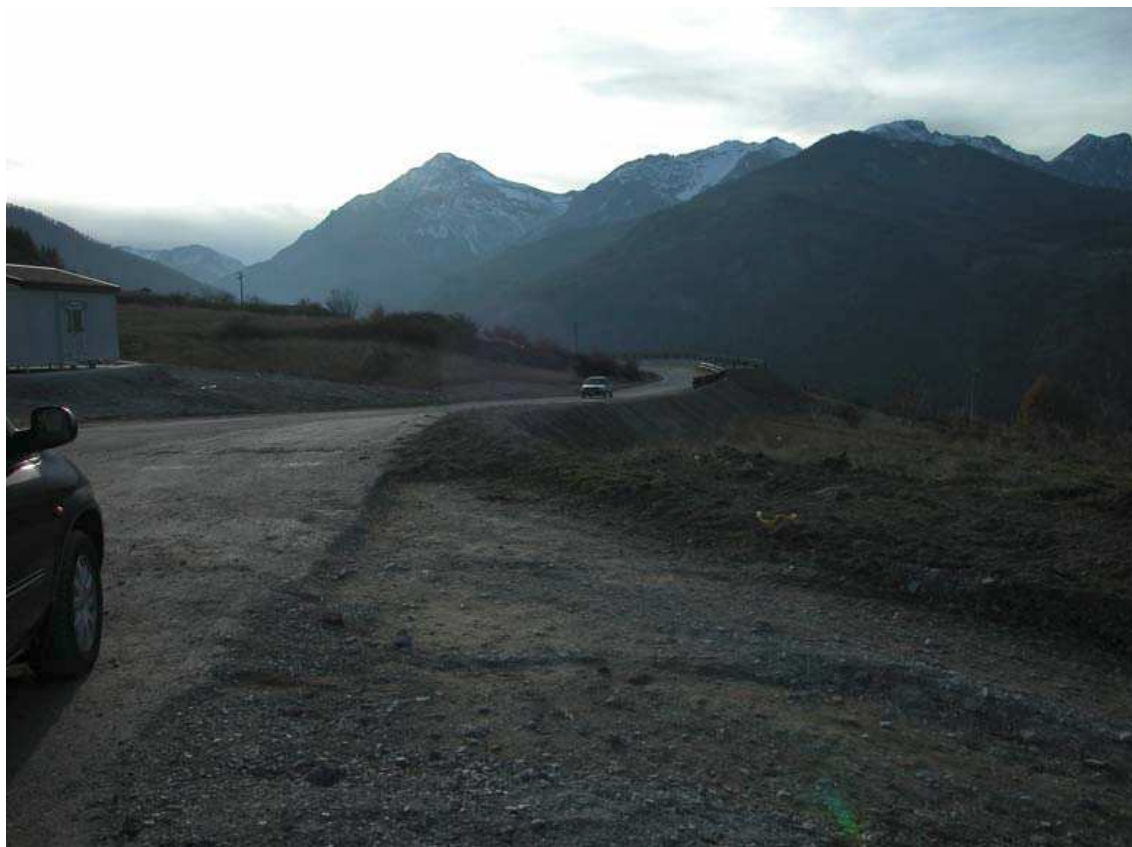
Strada di accesso all'impianto sportivo del free-style (da nord)
